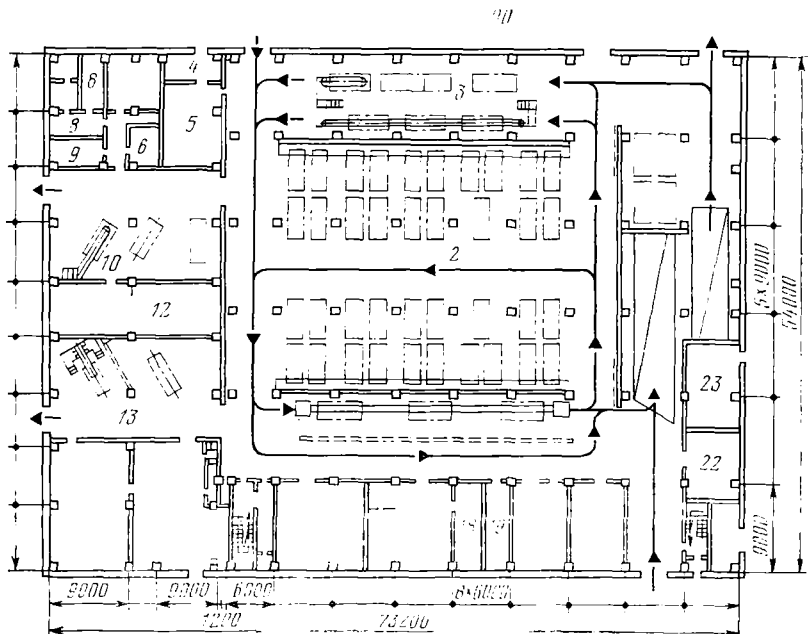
Планировка 1-го и 2-го этажей по типовому проекту АТП на 325
